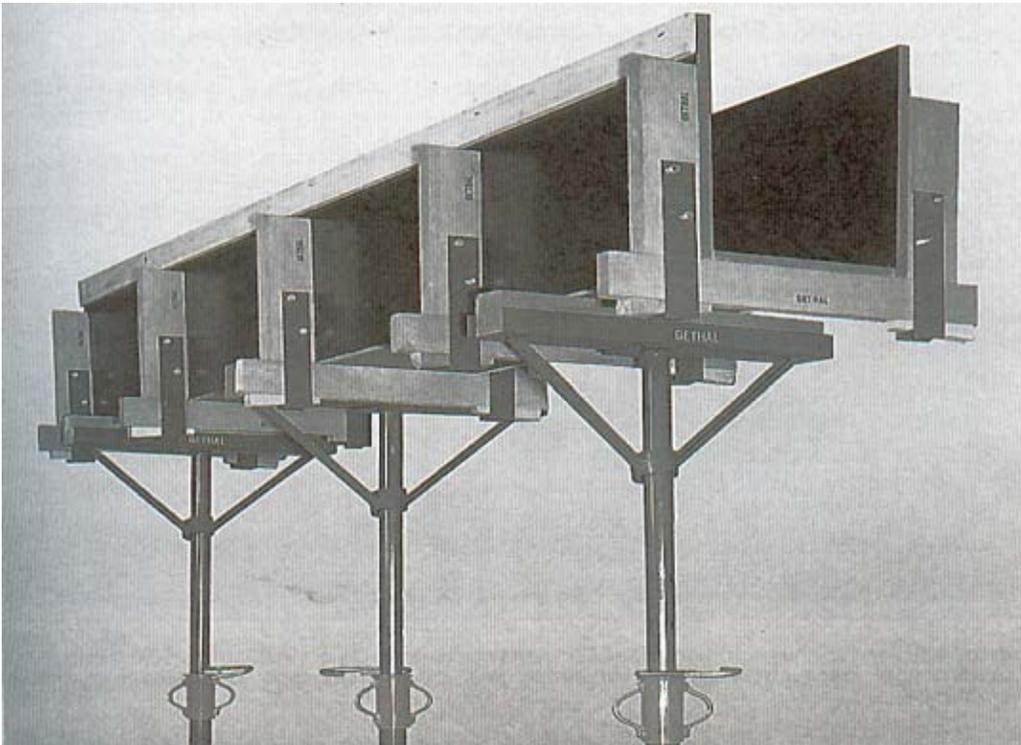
Elementos metálicos componentes de moldajes de hormigón, moldaje Ghetal. Cortesía Empresa DOM.
